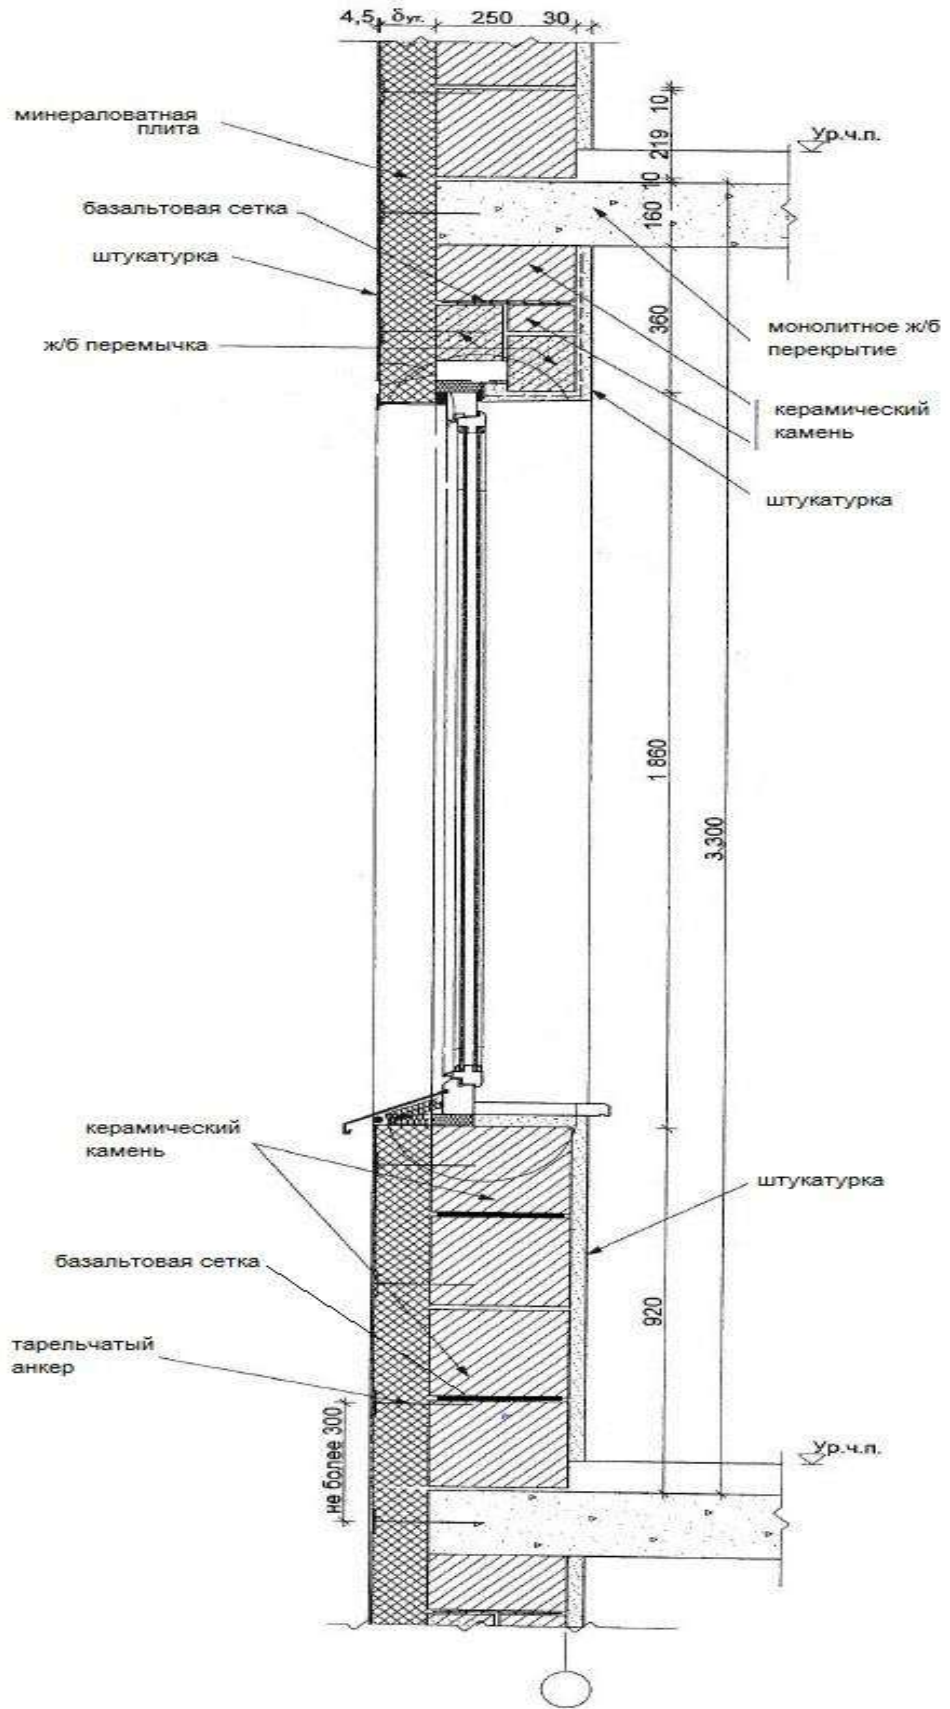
Конструкция двухслойной стены с наружным теплоизоляционным слоем в зоне оконного проема
